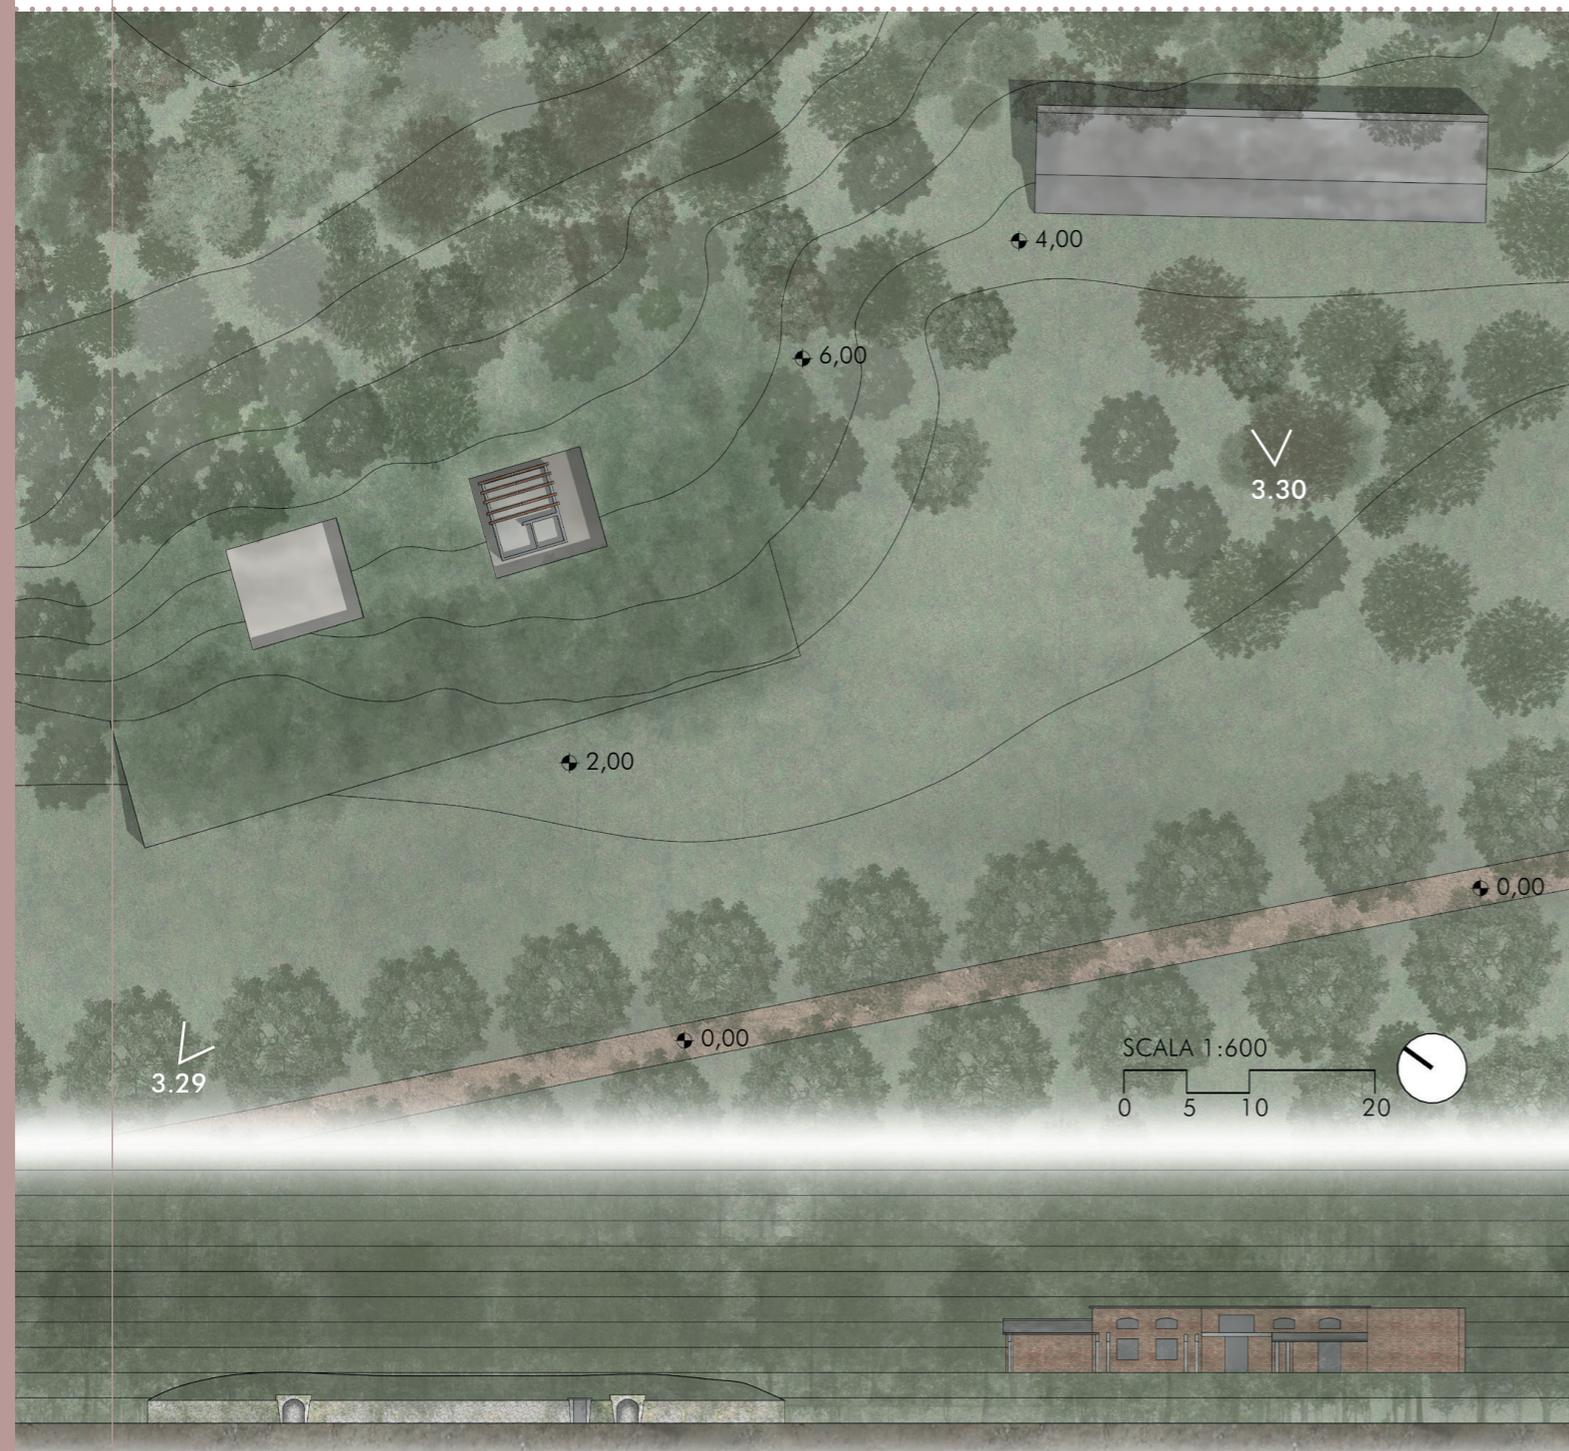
Planimetria e prospetto principale del secondo polo, stato di fatto, elaborazione dalle autrici
